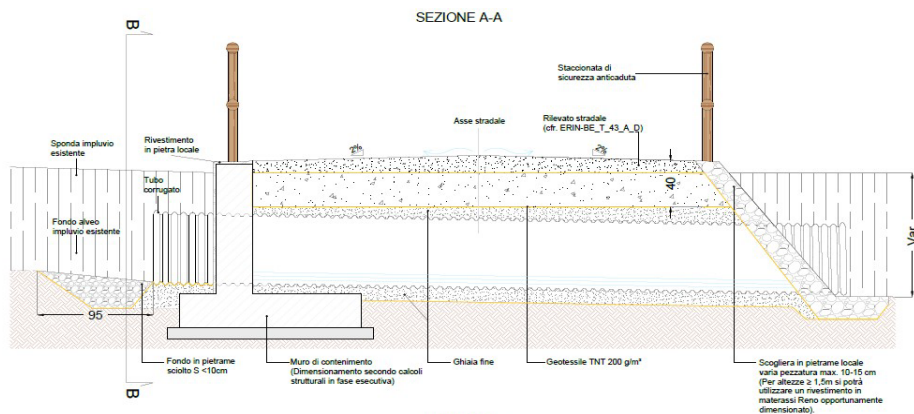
Sezione tipo dell'attraversamento stradale di un impluvio – tutte le misure in cm
